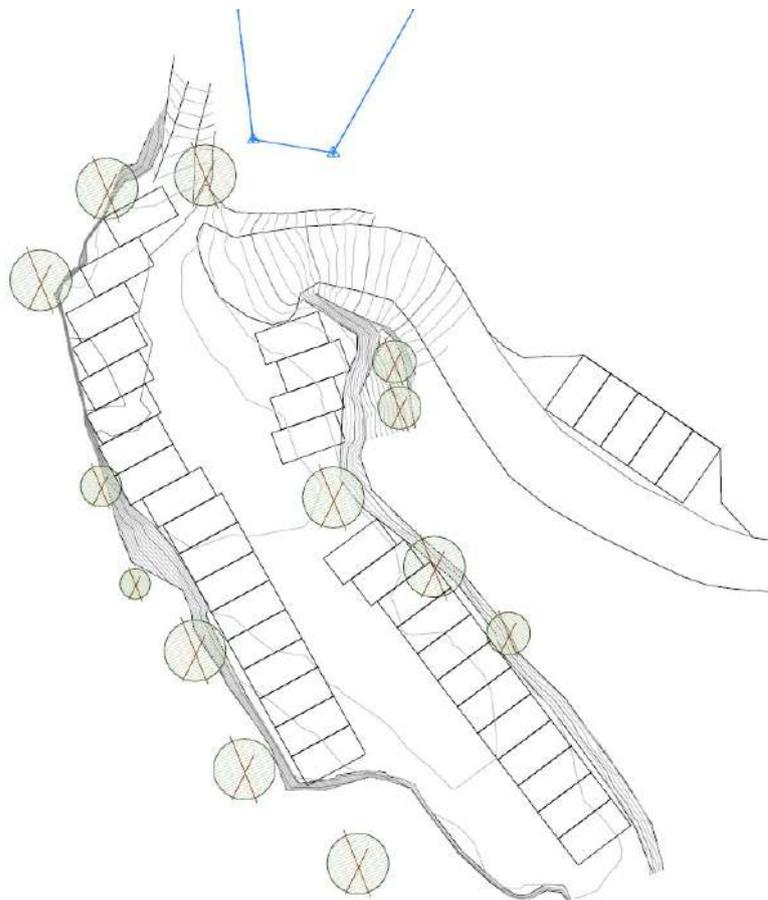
Plano de la alternativa 2 de aparcamiento alineado y abarcando el camino.
